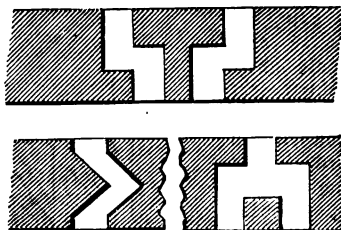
Grundrissformen von Luftöffnungen.
